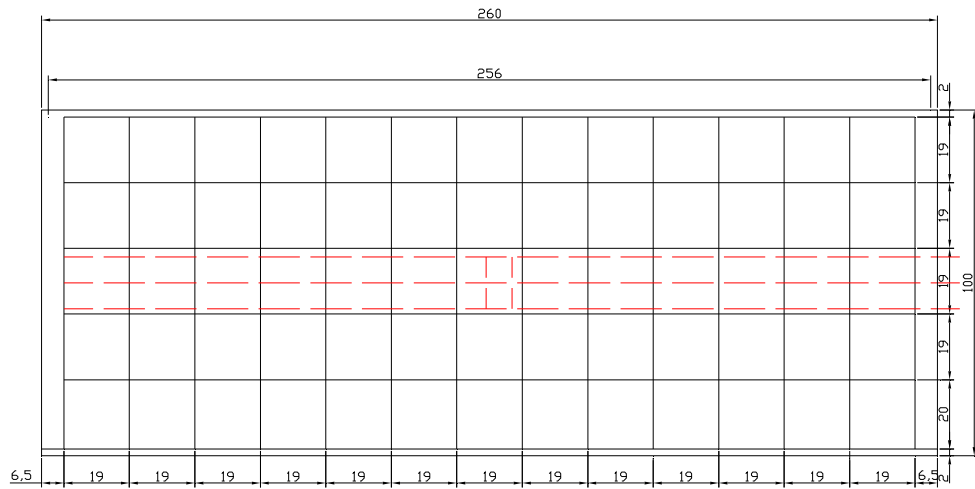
Detalhe da armadura da malha inferior.
